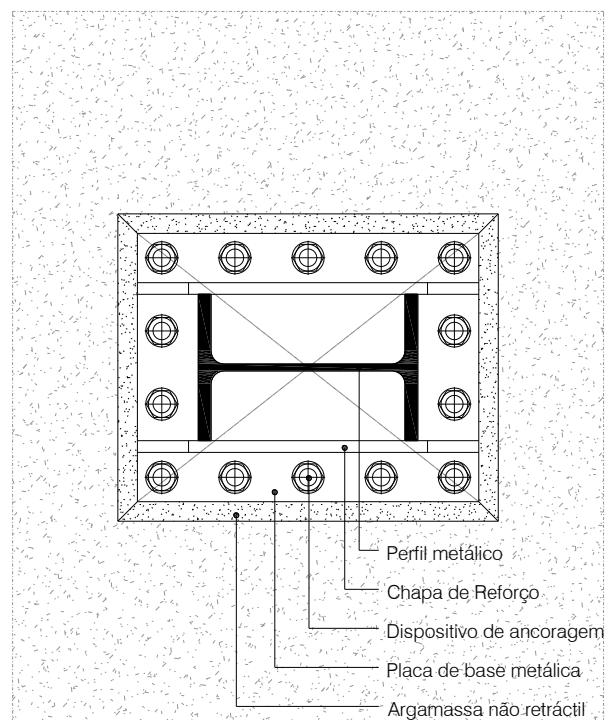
Exemplo de constituição em planta de uma ligação aço-betão. [SE2P]
